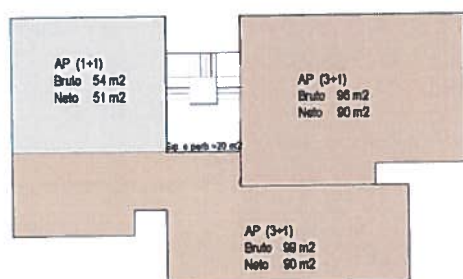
Planimetria katit te pestë dhe gjashtë
